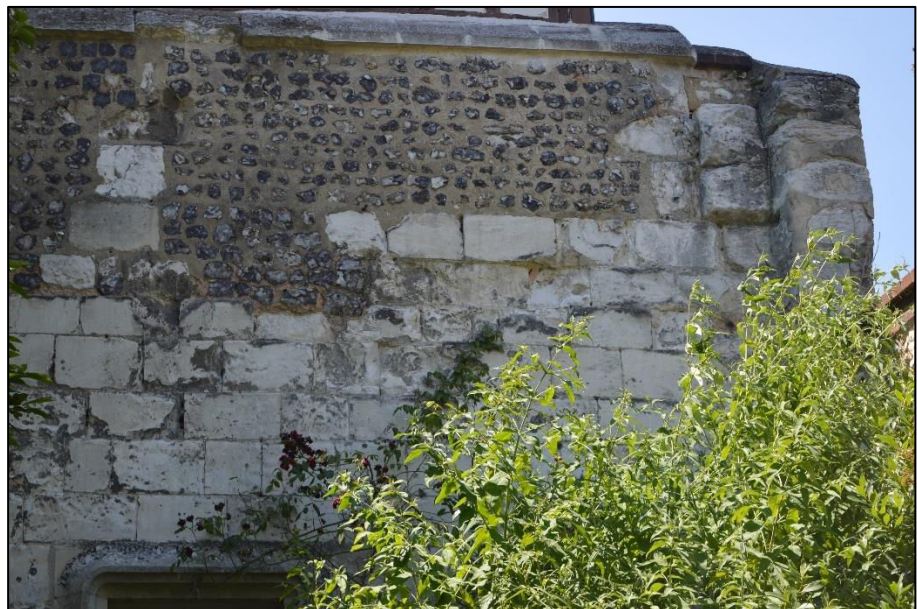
Bâtiment nord, façade orientale, retour de mur (© Lise Levieux).
